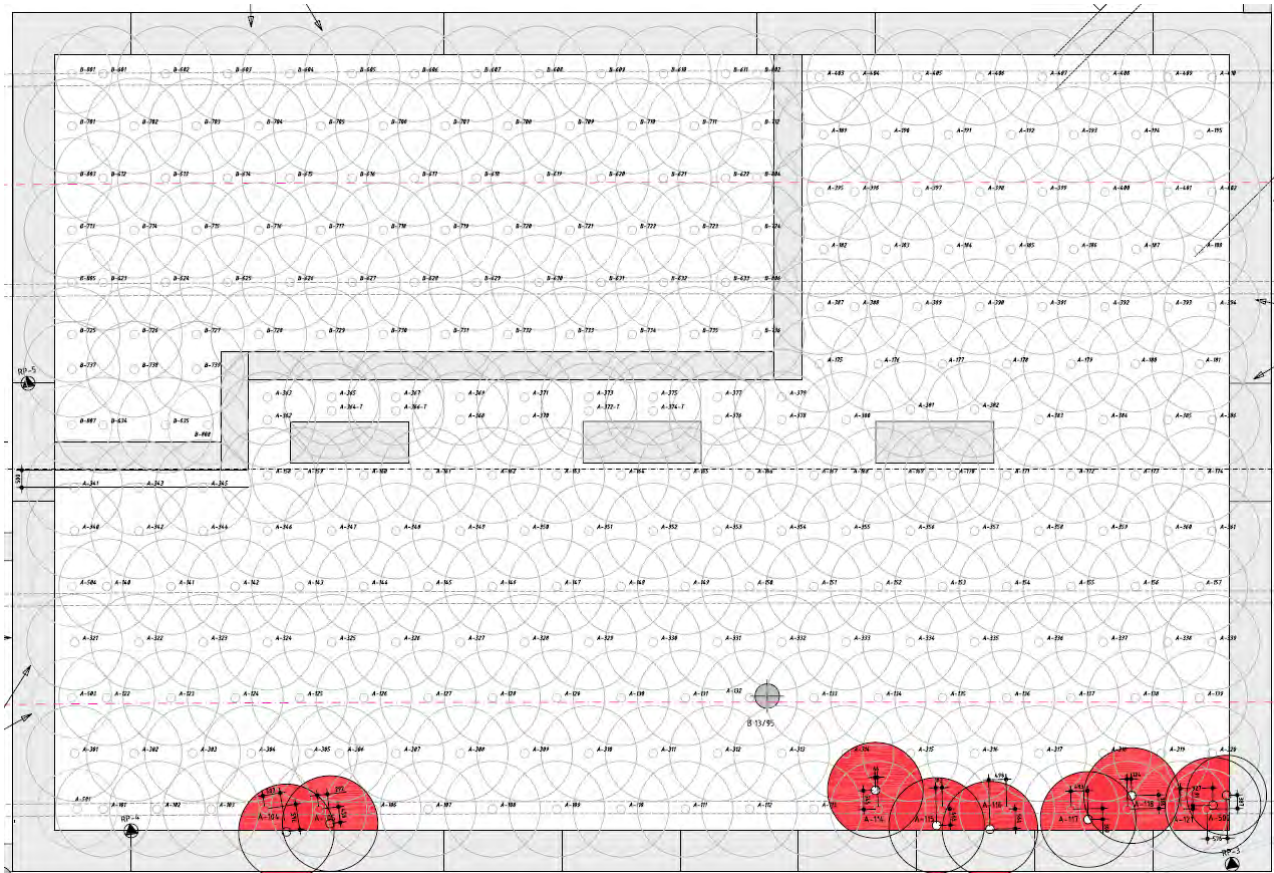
Ausführungsplan Westschacht, Grundriss tiefliegende Dichtsohle, mit ersten IST-Lagen [3]
